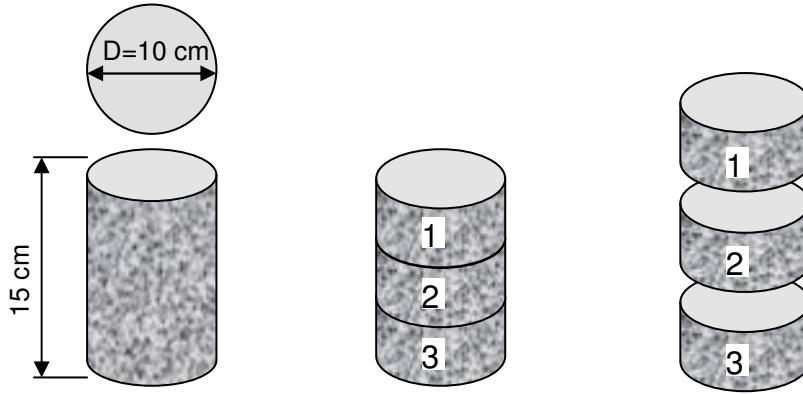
Beton blok yüzeyinde hava boşluğu ölçüm bölgeleri
